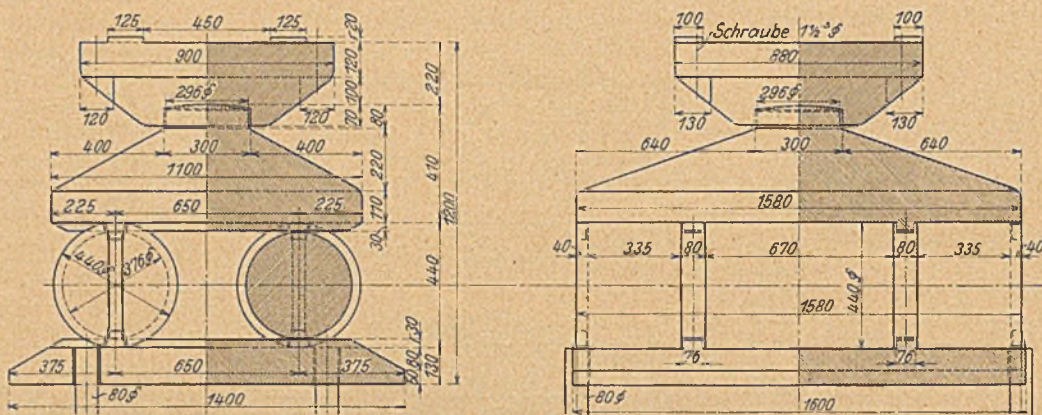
Bewegliches Hauptträgerlager des großen Überbaus.
